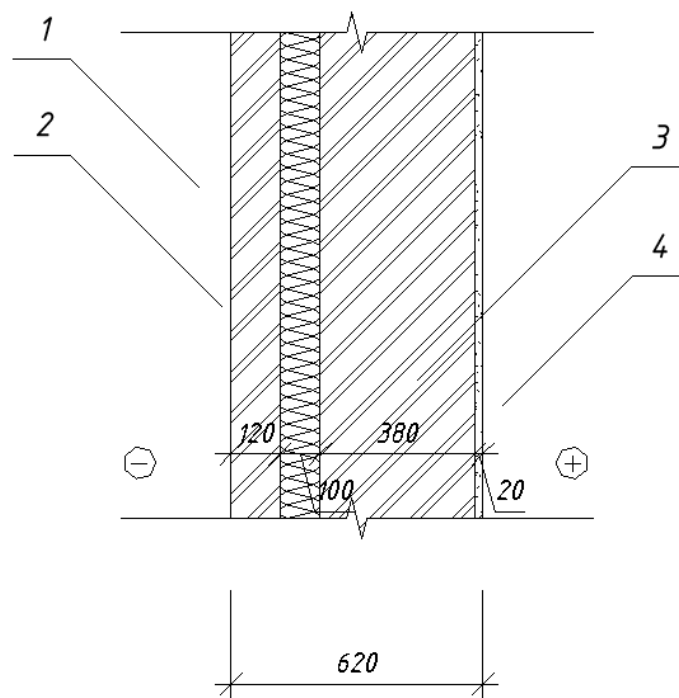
Второй вариант ограждающей стены с утеплителем KNAUF Therm Fassad
